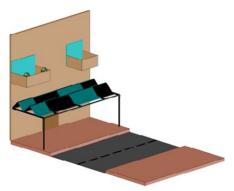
Sistema de apantallamiento acústico en fase de plegado
